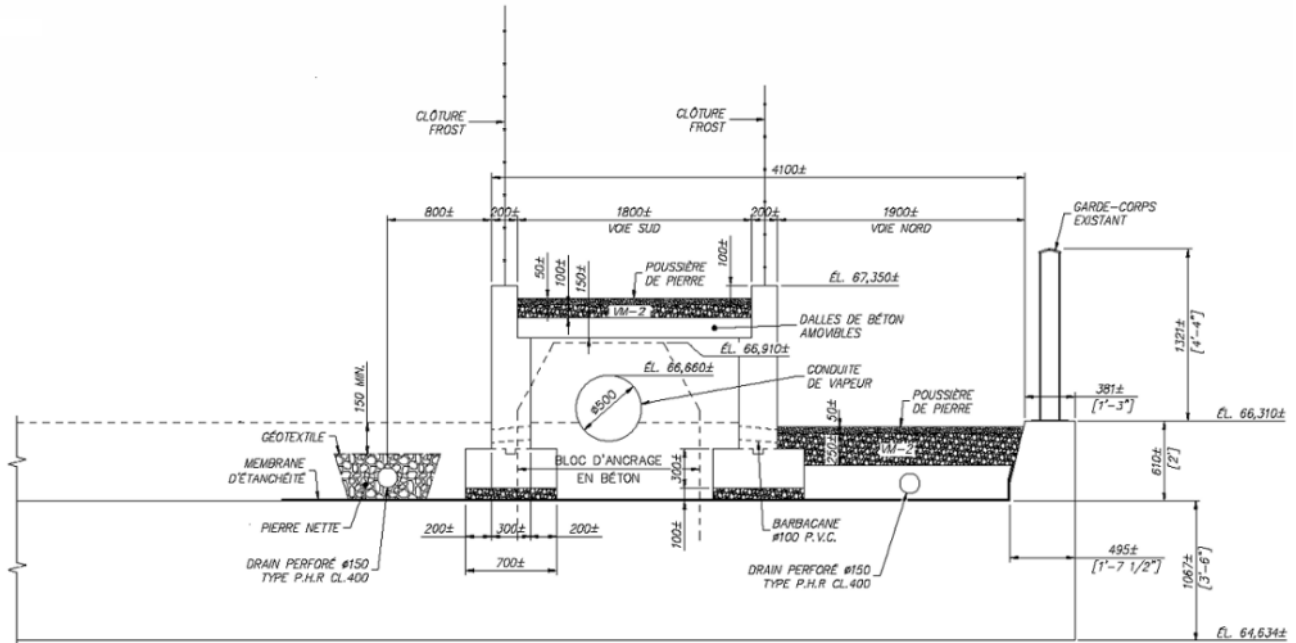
Pont ferroviaire P.F. 81-5170B - Piste cyclable – Coupe type
